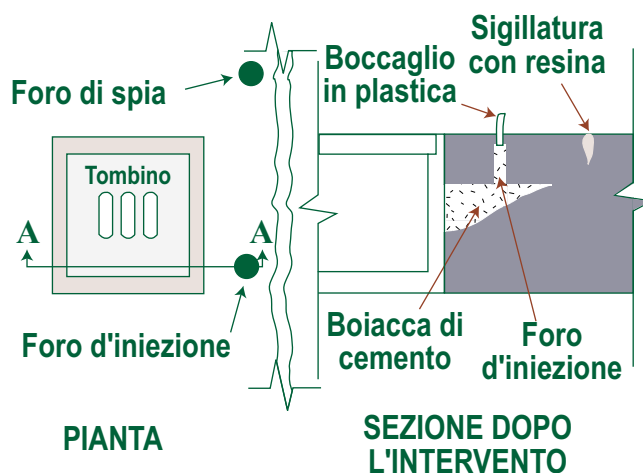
Intervento di consolidamento in una pavimentazione fessurata per cedimento del sottofondo in prossimità di un tombino
